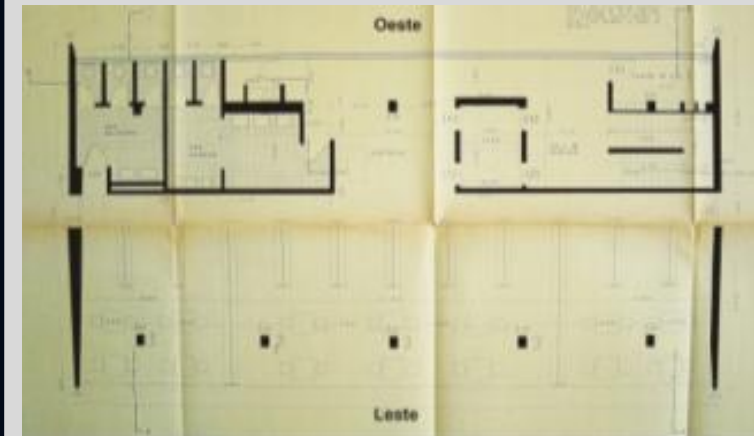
PLANTA BAIXA DO PAIVEMENTO TIPO.
